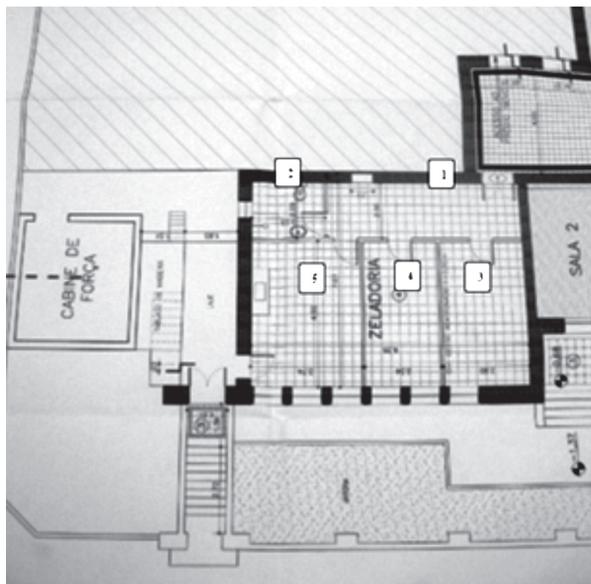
Planta do pavimento térreo do edifício monumento tombado, em 2010, com destaque da Planta do Centro de Memória da Etec Carlos de Campos com cinco divisões internas em alvenaria (espaço original do Dispensário de Puericultura), desde 2014.
